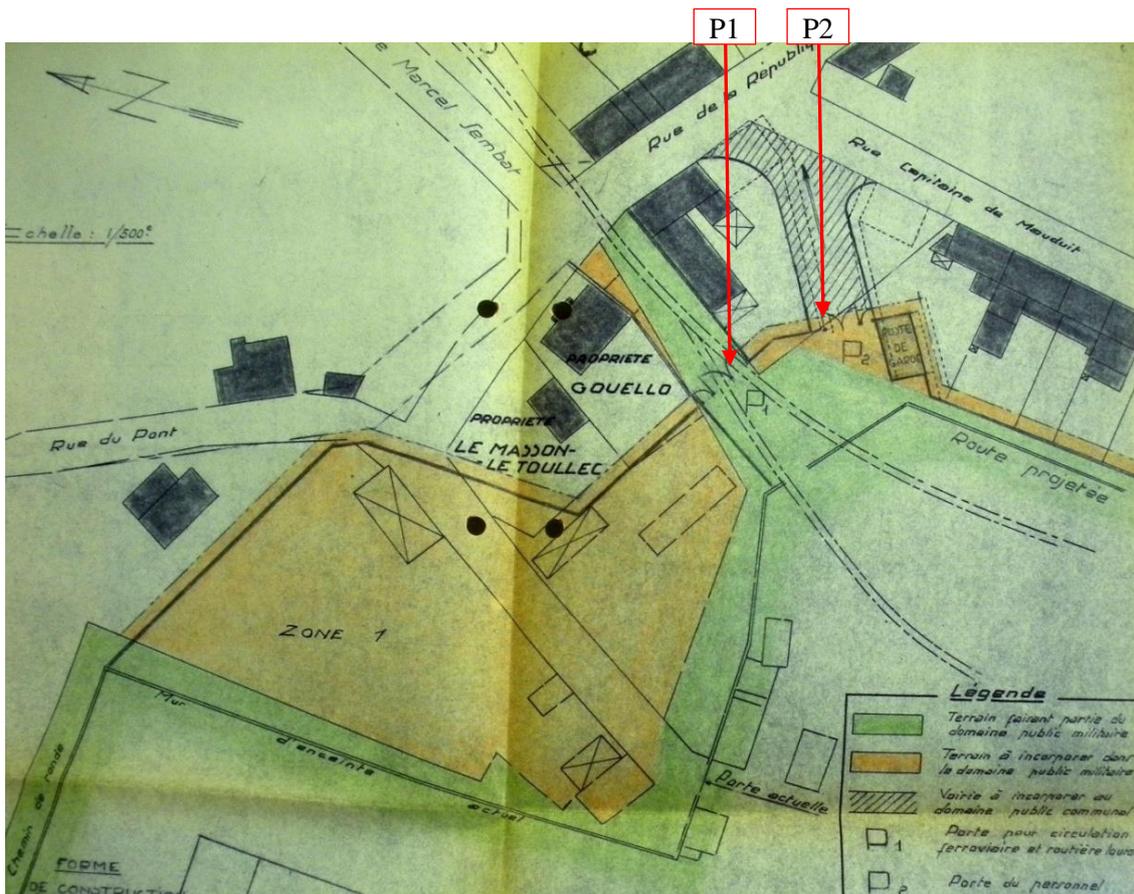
Zone 1, extension prévue à l'est de la forme de construction, aménagement des nouveaux accès à l'arsenal « P1 » et « P2 »
